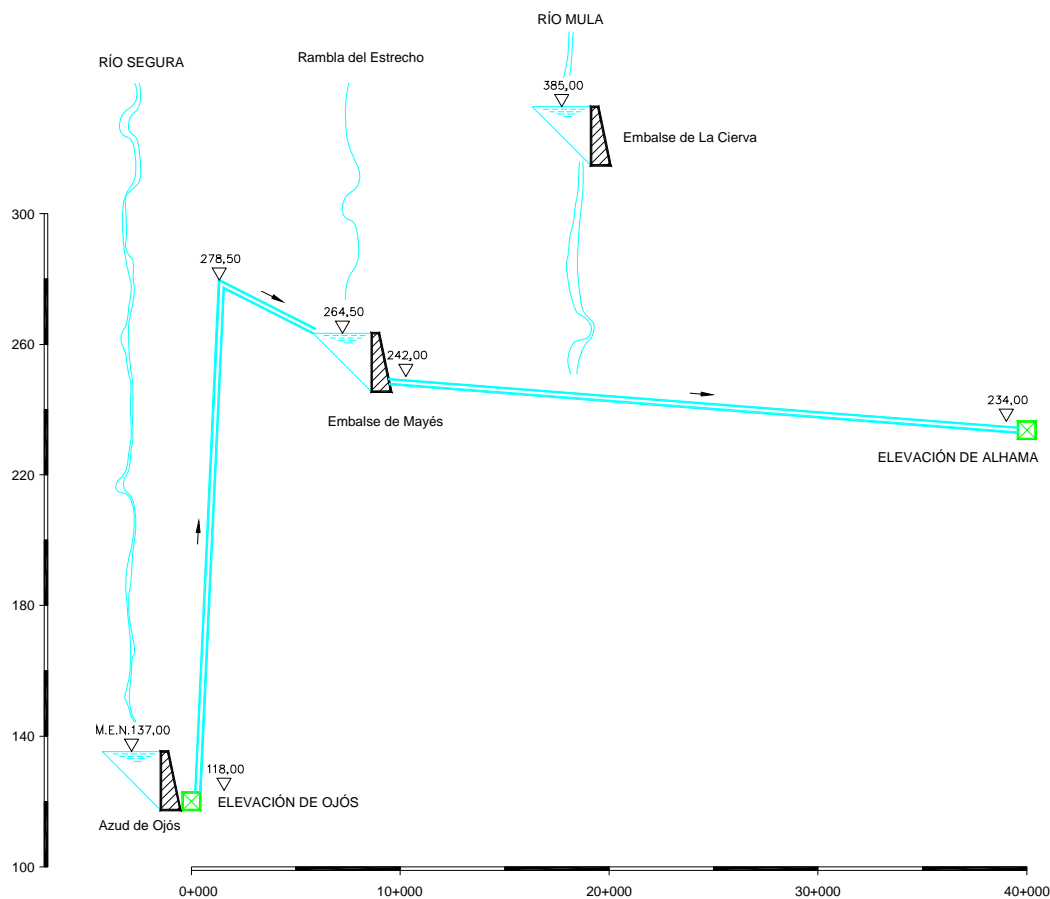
Conducción Ojós-Algeciras. Esquema en alzado
